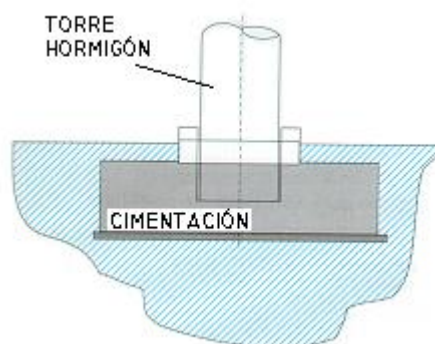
Cimentación con torre tubular de hormigón prefabricadas
